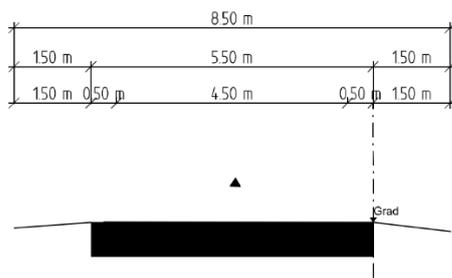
Rampenquerschnitt Ein- und Ausfahrten PWC-Anlage Auergründel
